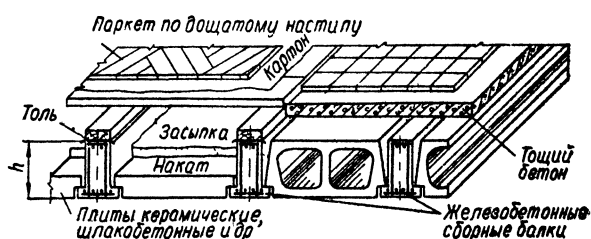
Перекрытие из сборных железобетонных блоков.
